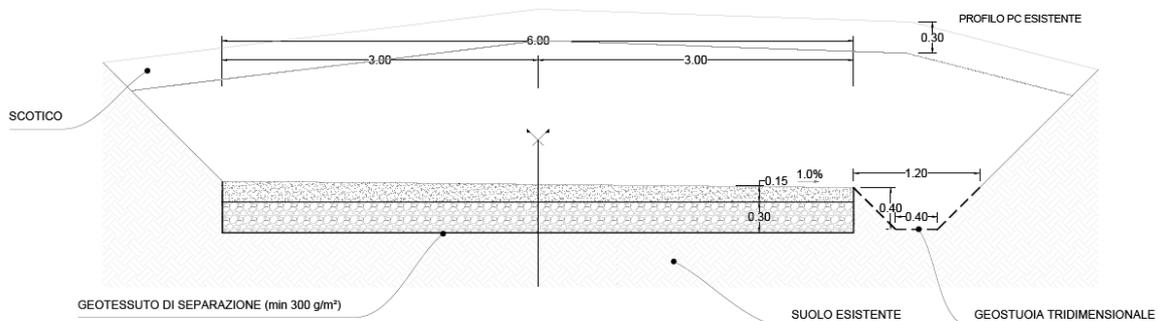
Sezione trasversale viabilità di nuova realizzazione. Fonte: elaborato di progetto "C21BLN001DWD01900\_ Sezione stradale tipo e particolari costruttivi"
